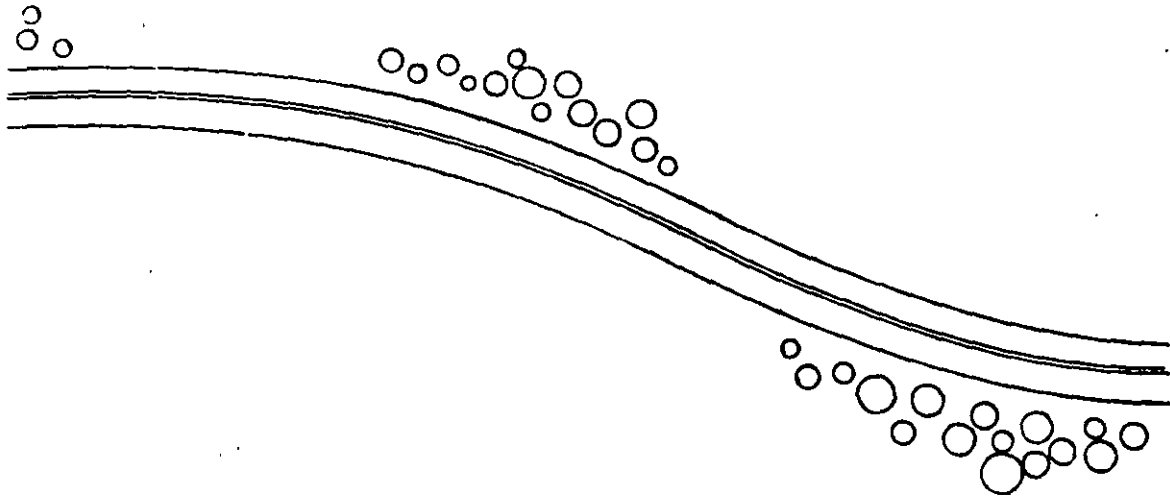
CRITERIO DE PLANTACION EN CURVA HORIZONTAL
